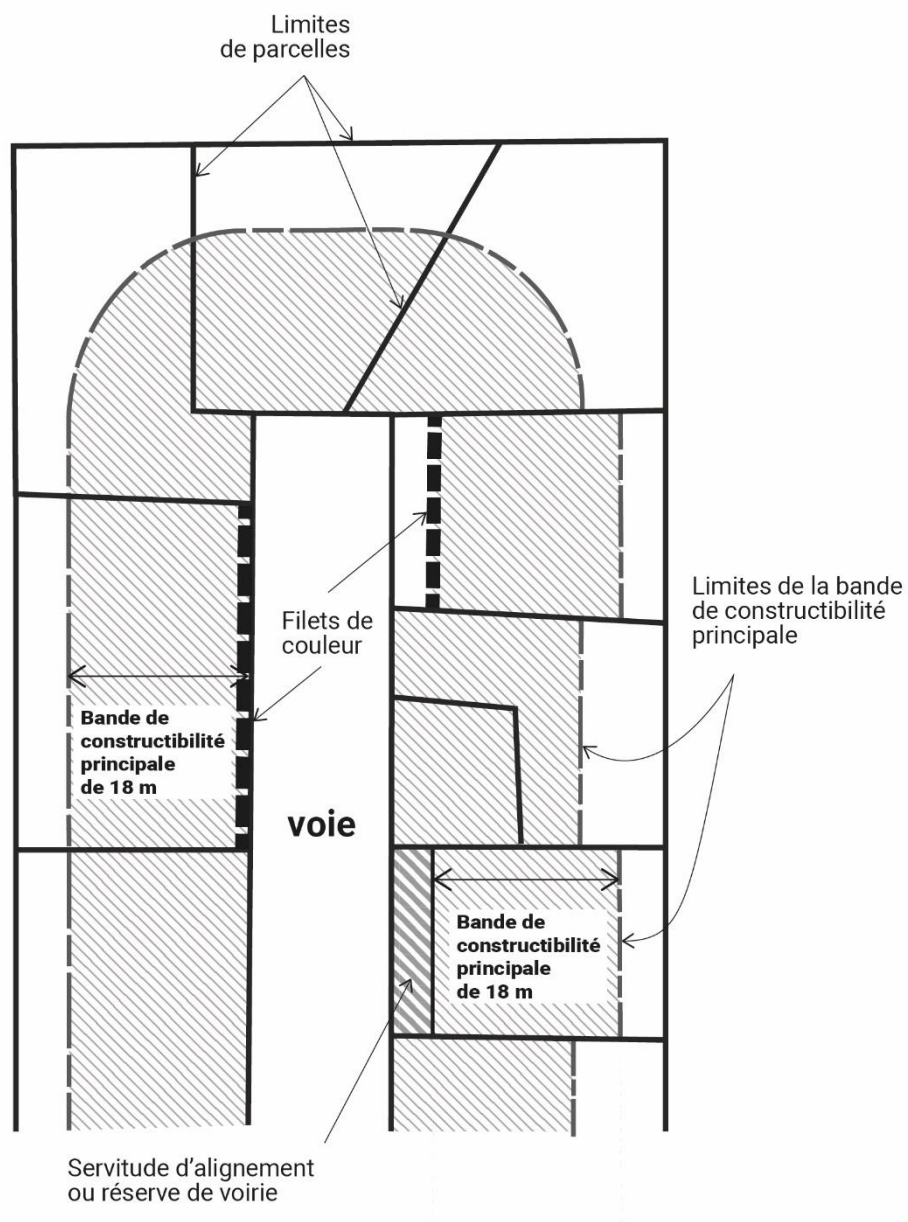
(Partie 2, définitions)Détermination de la bande de constructibilité principale* en bordure de voie
